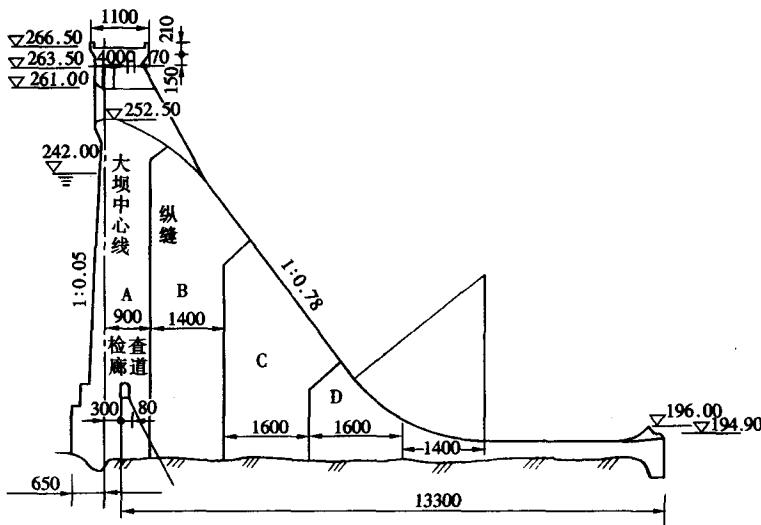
溢流坝段剖面图 (尺寸单位: cm, 高程单位: m)
